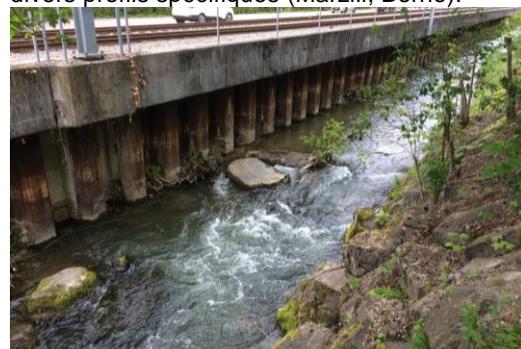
Rideau de palplanches construit le long d'une voie ferrée pour protéger la rive contre l'érosion (Worble, Ittigen. OPC 2021).
